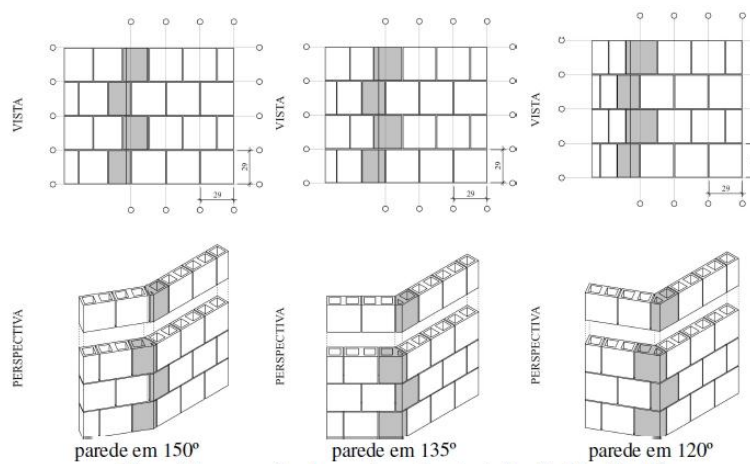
Ilustração de alvenaria com blocos de concreto.
